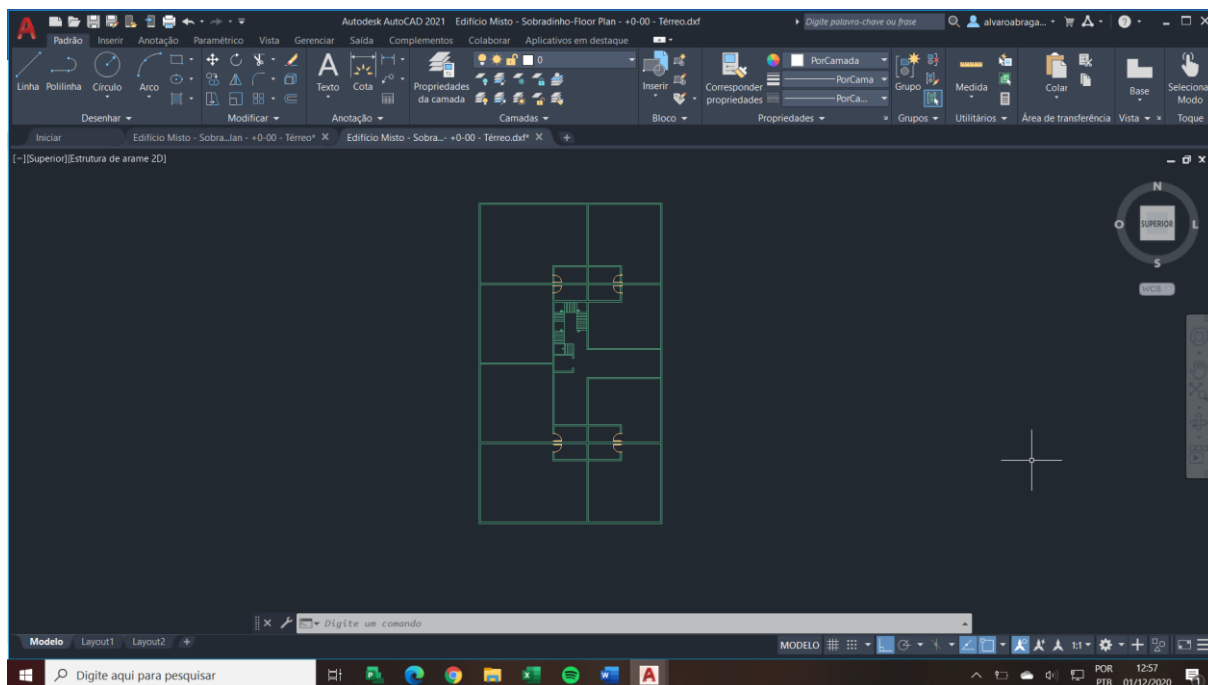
Planta baixa do térreo, em DWG. Realizado pelo autor.
